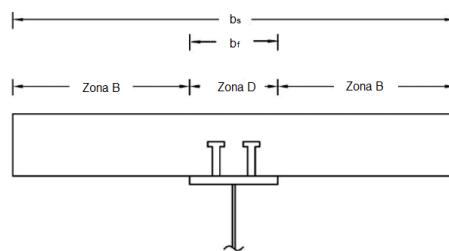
Regiões B e D no plano transversal da laje. Adaptado de [23]
